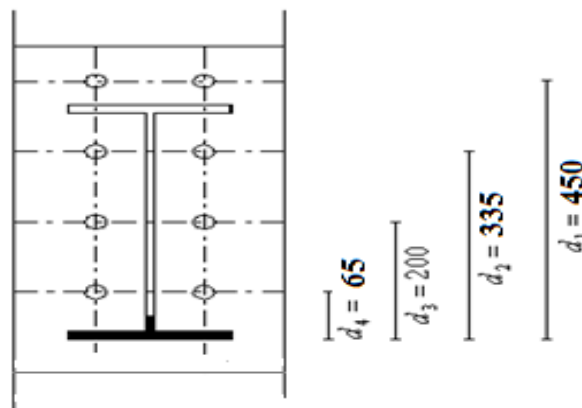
Disposition des boulons dans l'assemblage poteau –poutre
